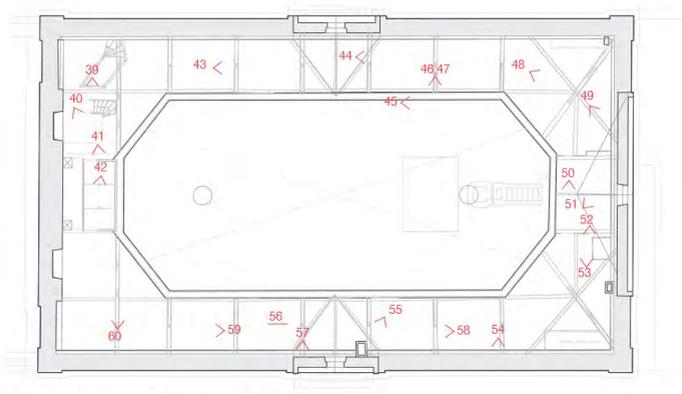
Plan des combles. HKD + Atelier Féroué 2017.
